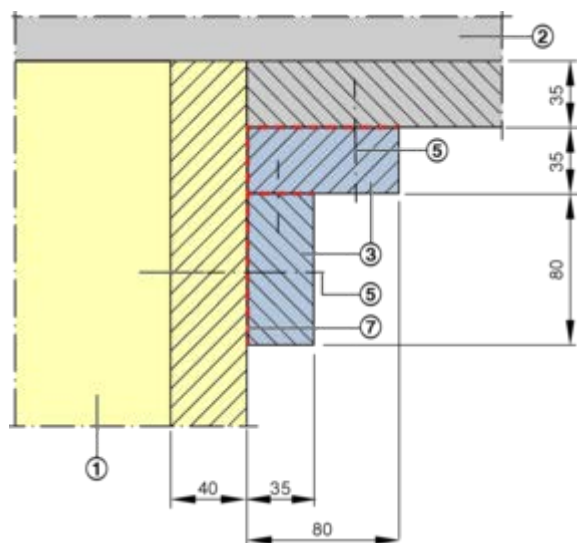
Dettagli di installazione C2: collegamento profilo angolare, serranda nel condotto
